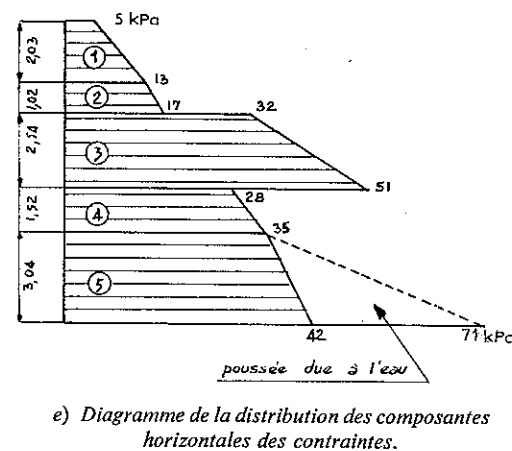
(suite). — Poussée d'un massif stratifié.
